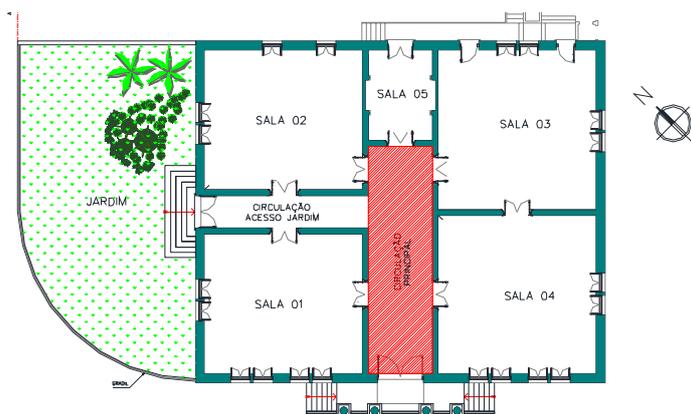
Circulação principal de entrada com destaque na planta baixa.
